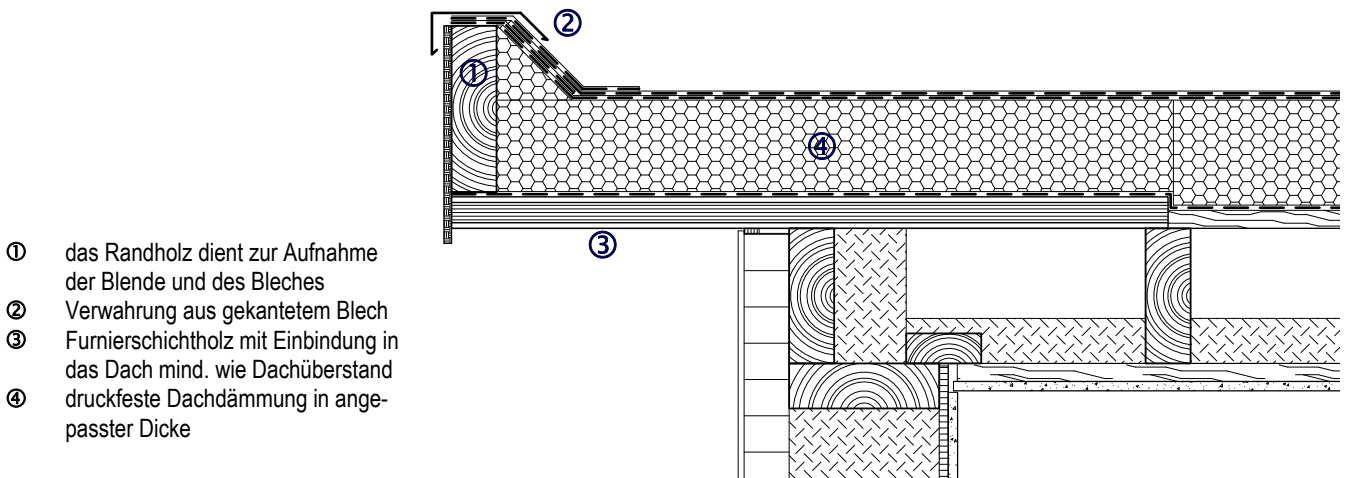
Für ein Flachdach (Typ I, „80/20“) wird hier der Dachrand dargestellt. Soll die Dachkante sehr schlank bleiben, kann mit einer Furnierschichtholzplatte ③ der Überstand tragend hergestellt werden.
